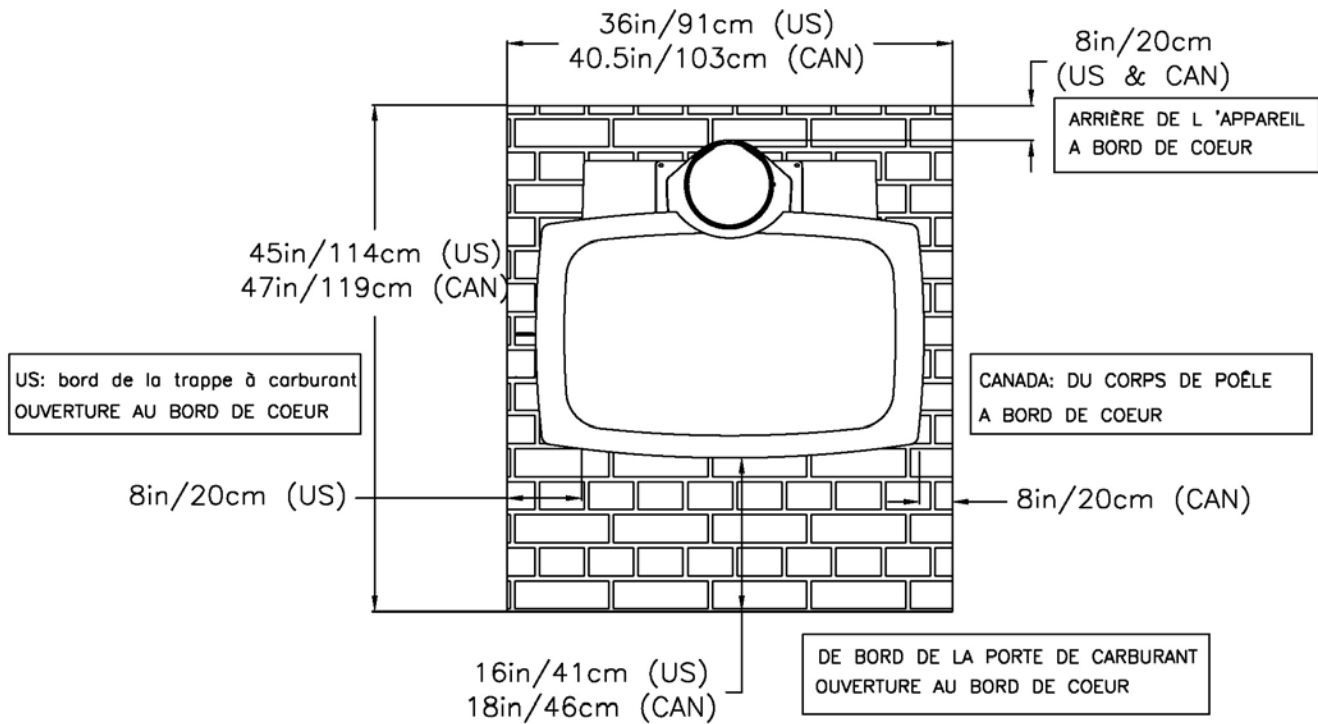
8371 Dimensions du Recouvrement de Plancher
